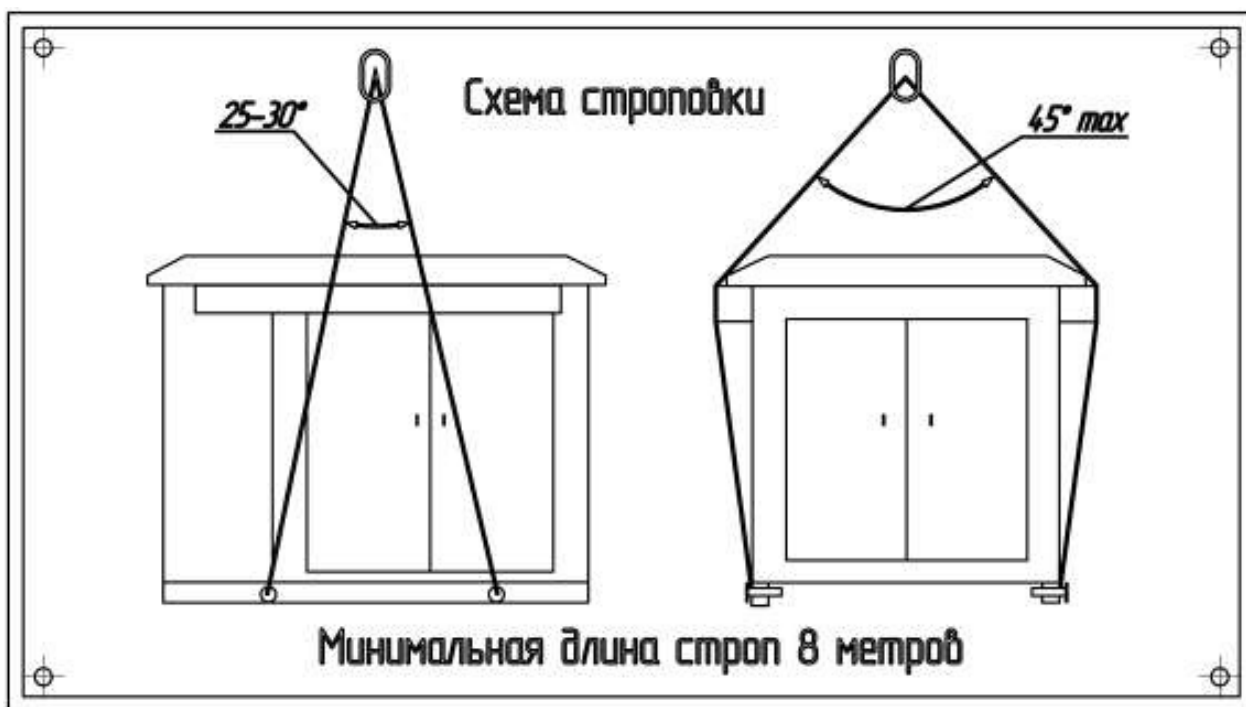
Схема строповки КТПНУ 400...1600 кВА РУНН двухрядная
